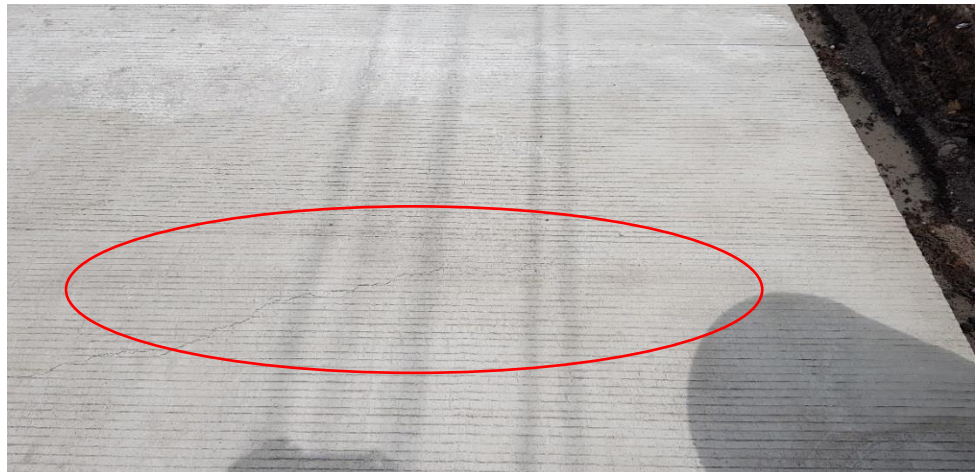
y 61: Fisuras presentadas en losas K0+051 y K0+090.
